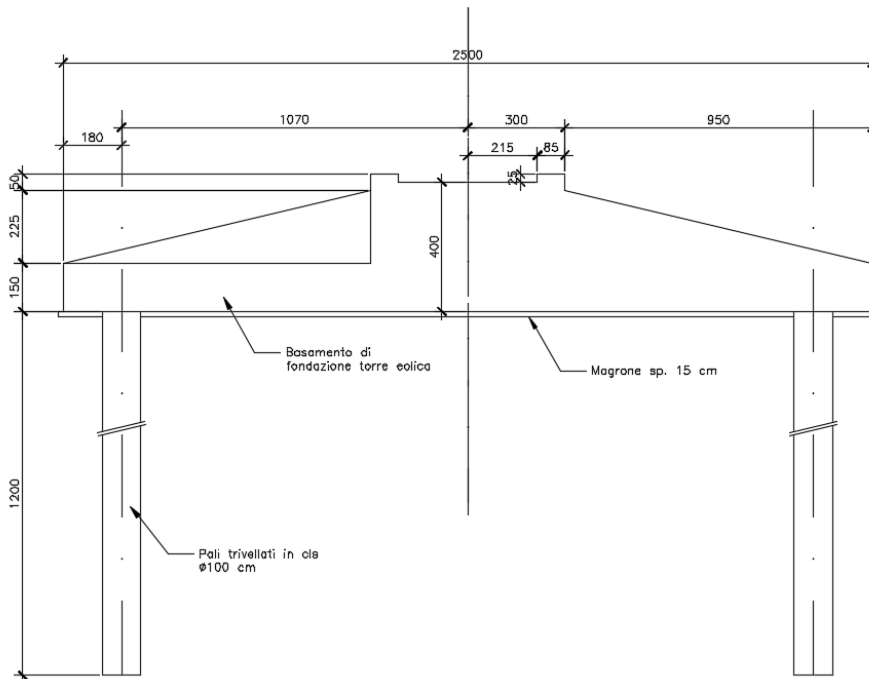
Sezione plinto di fondazione – “Configurazione 2”
